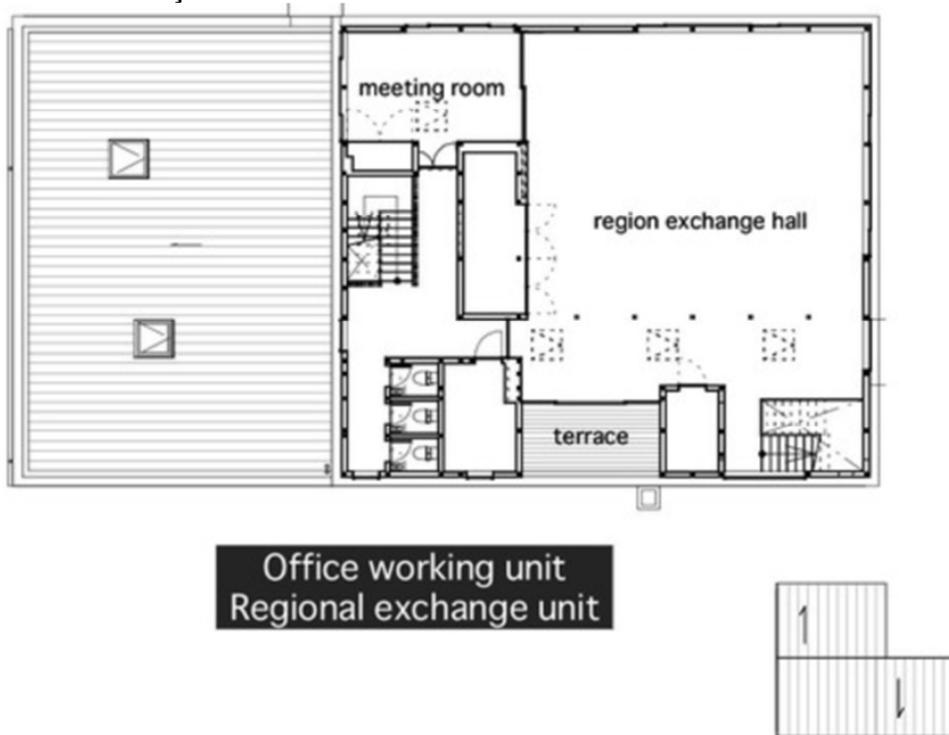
Planta baixa pav. inferior da "Unidade de Trabalho e Gabinete de Comunicação"
